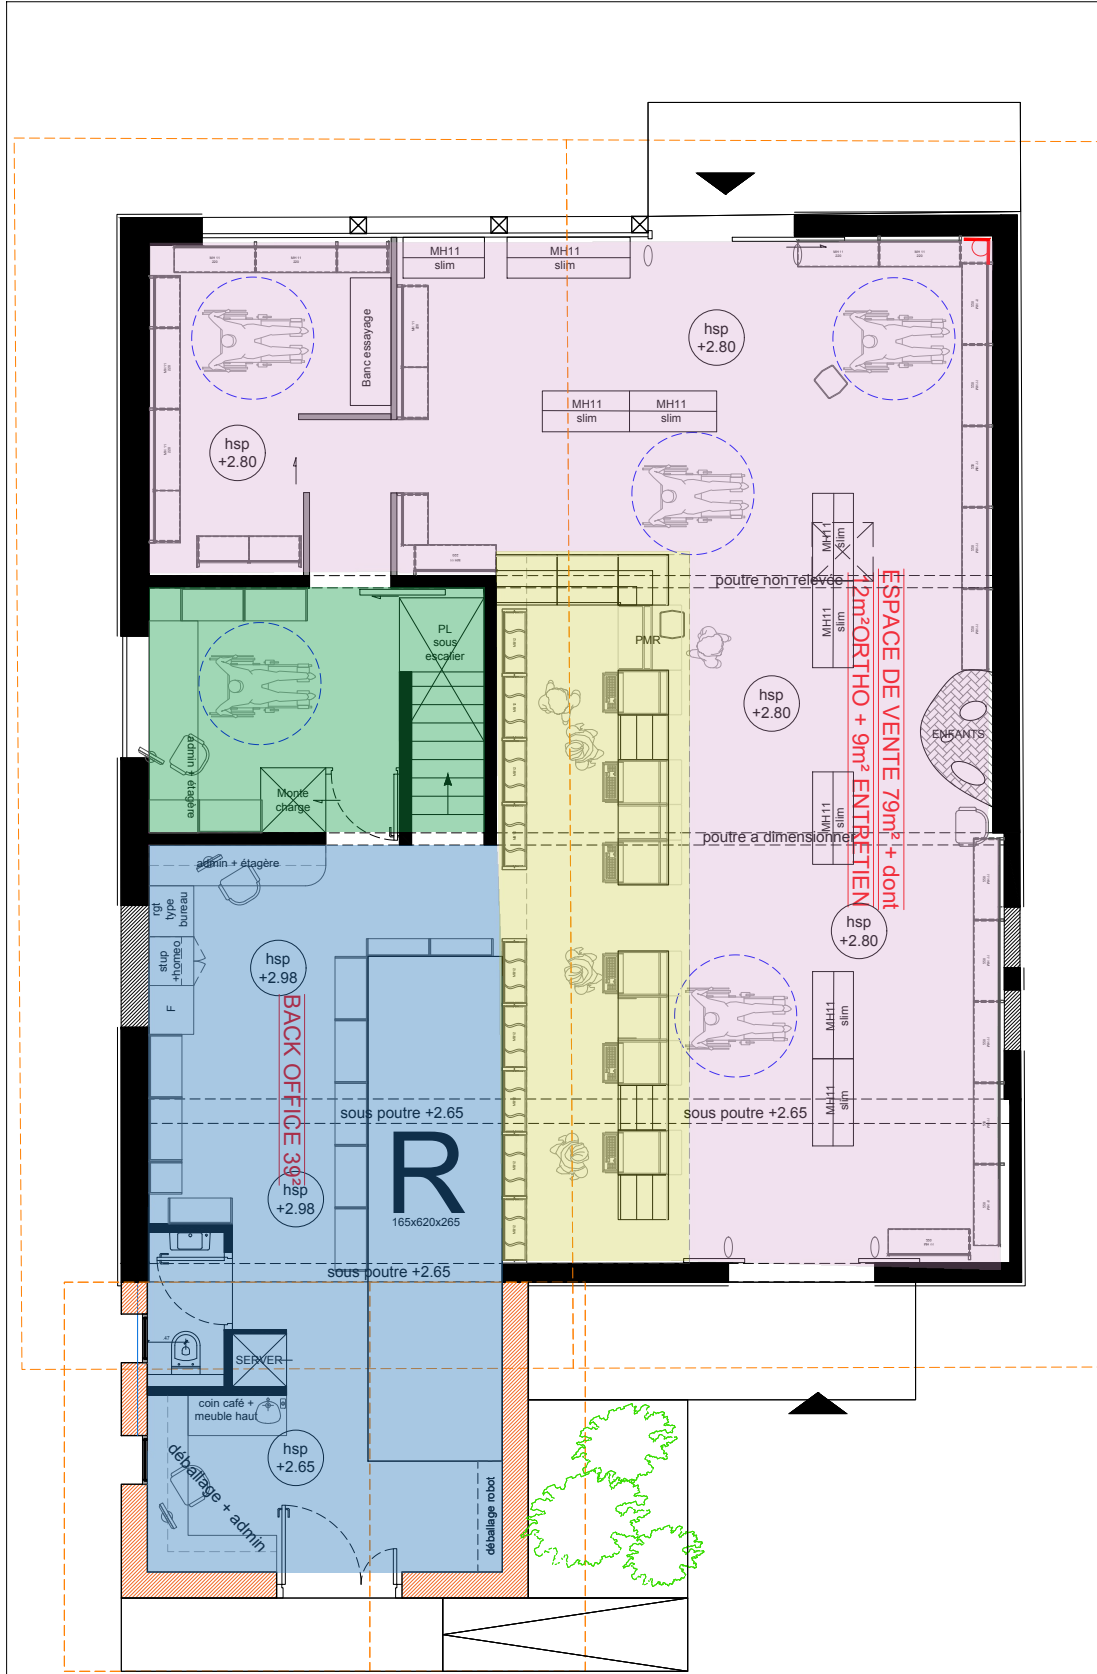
Plan final de réagencement du rez-de-chaussée de la Pharmacie du Trinquet
